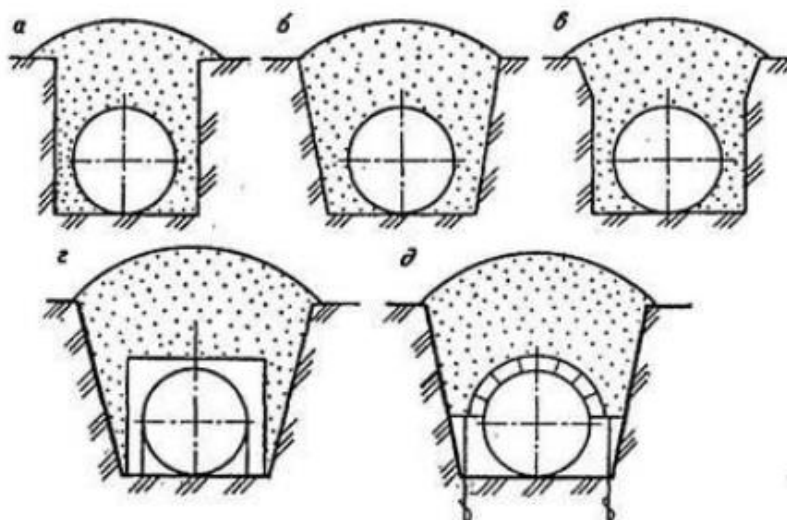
Схемы подземной прокладки трубопровода:
